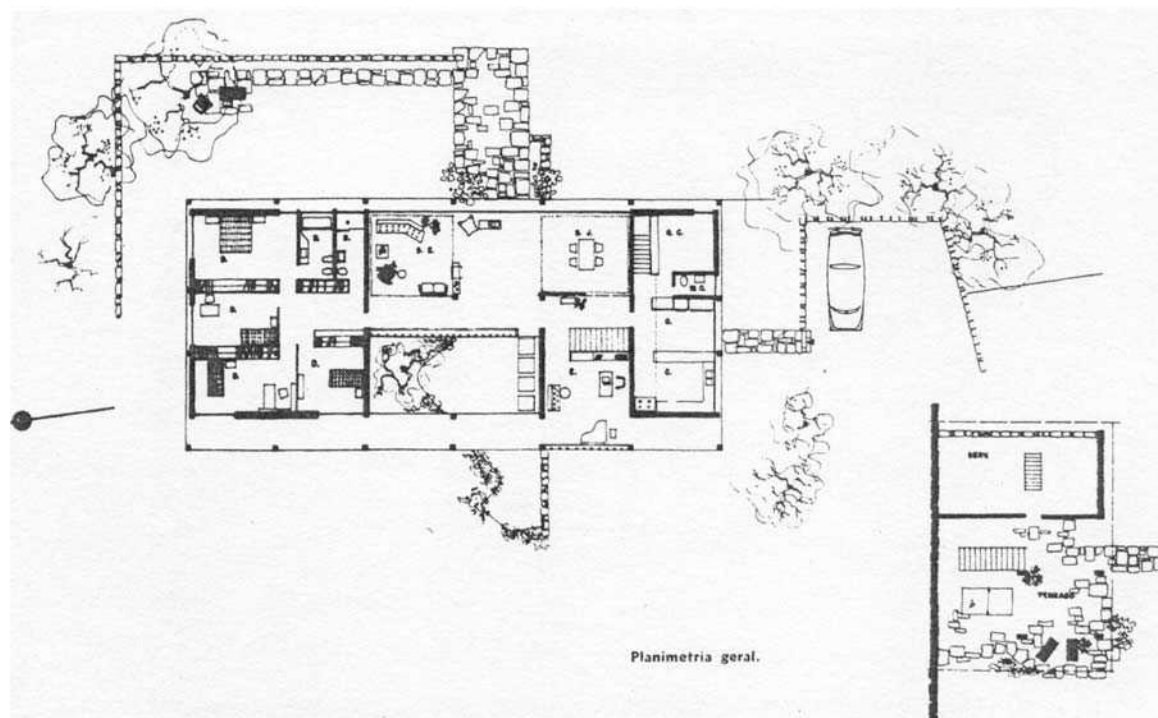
Plantas dos pavimentos – Térreo e rez do chão
